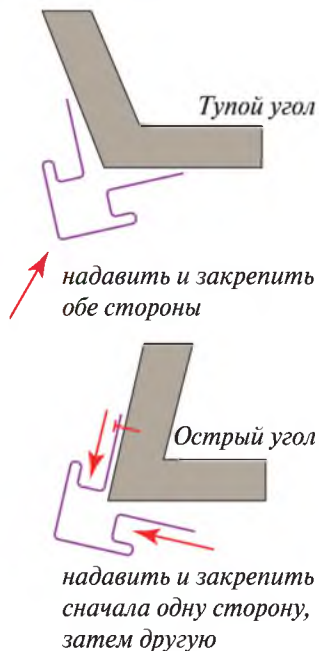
Монтаж угловых профилей на не прямоугольные углы
